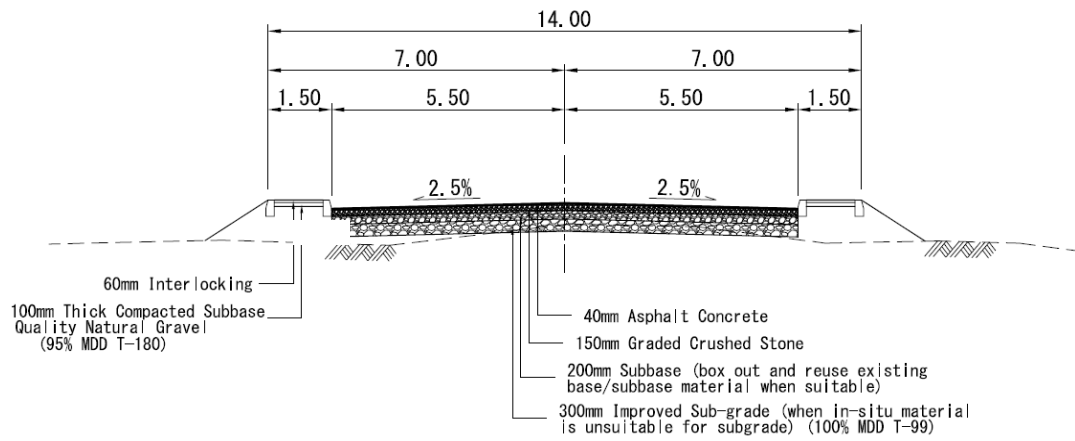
道路標準断面図 (計画) Road J3 (橋梁 No.10)
